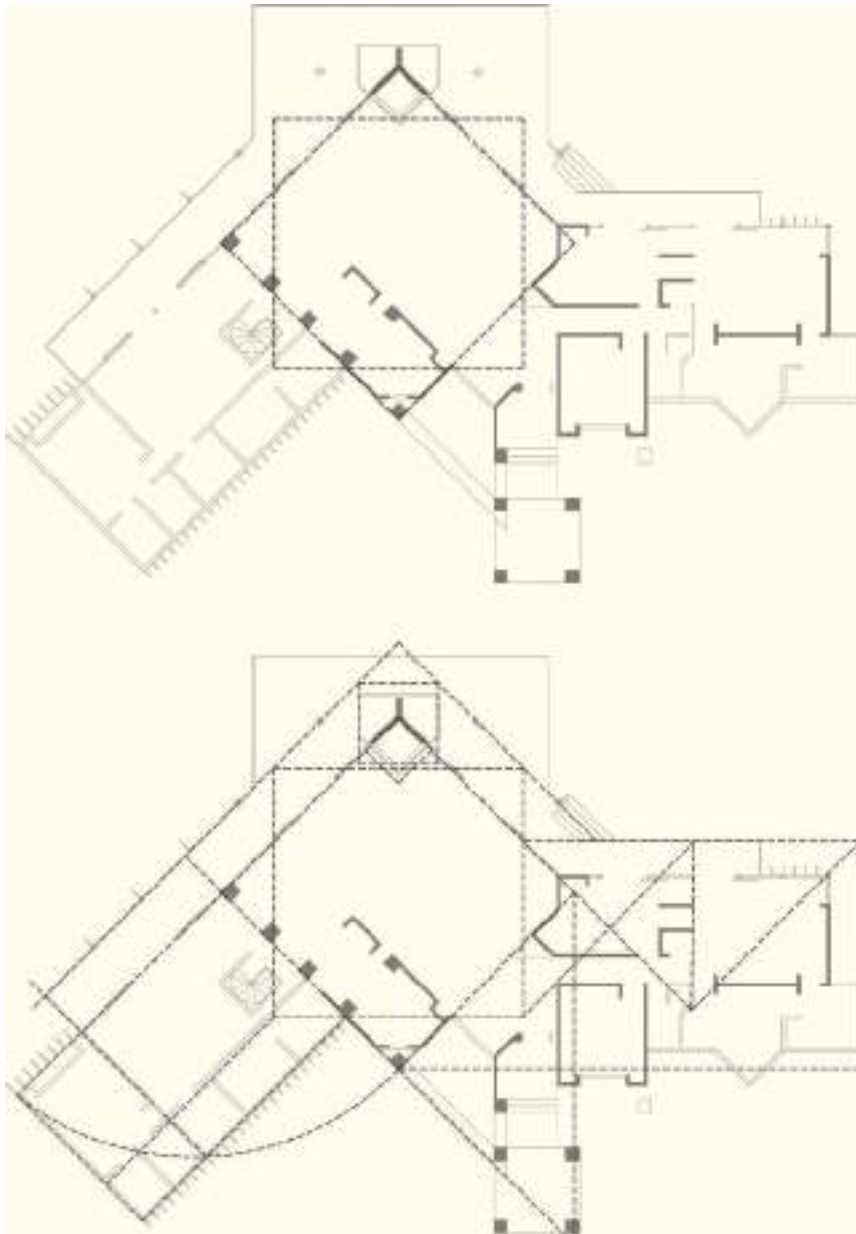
Dibujo sobre la planta arquitectónica de la casa Spinelli.
